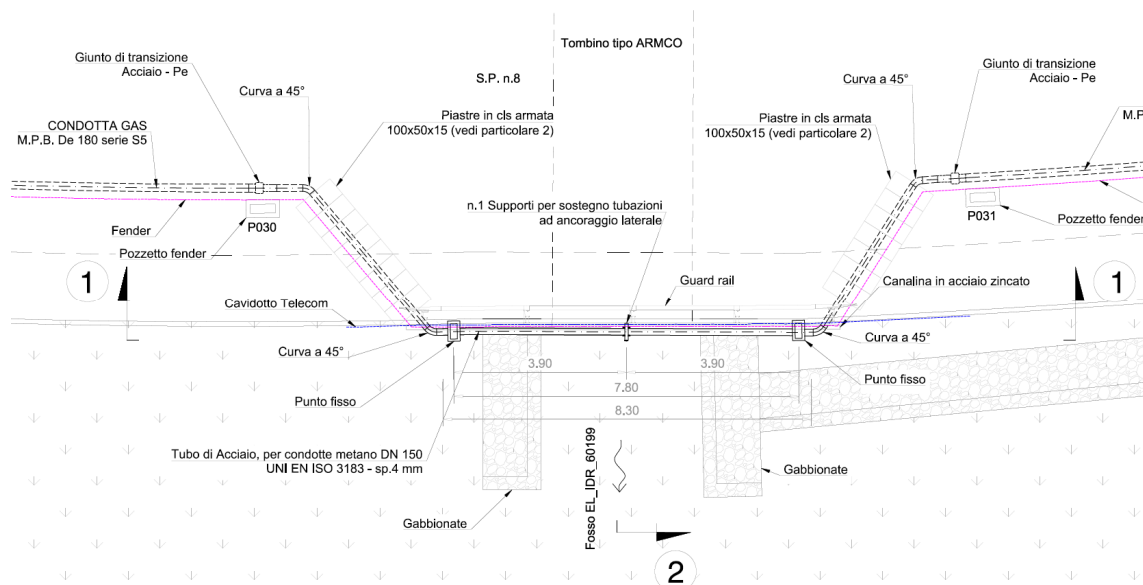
Planimetria di progetto – Attraversamento Rio Cintroxu
